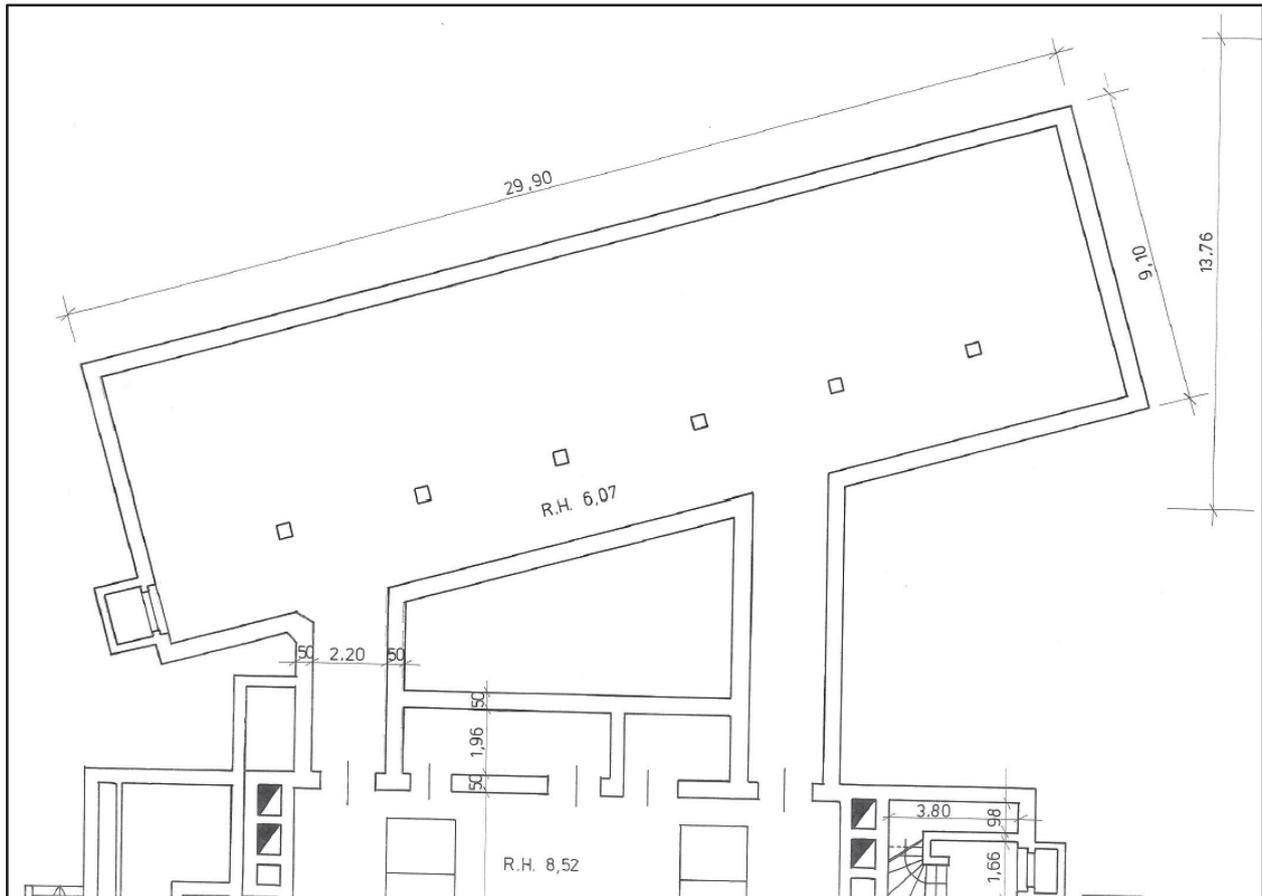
Grundrissplan ehemaliger Kohlebunker und Kellergeschoss Geb. 5809 (Quelle: DPW ED)
